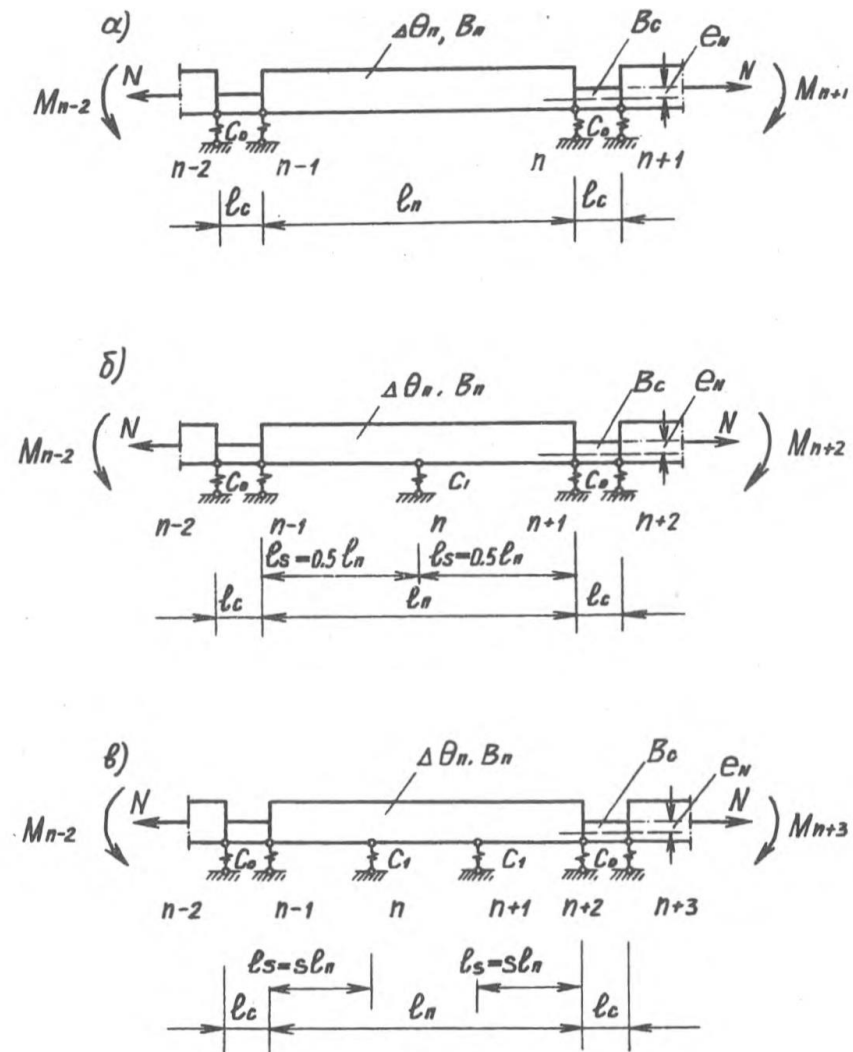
Расчетные схемы закрепления наружных стеновых панелей к внутренним стенам и перекрытиям: а - средняя панель без промежуточных опор в пролете; б - то же, с одной промежуточной опорой; в - то же, с двумя промежуточными опорами
